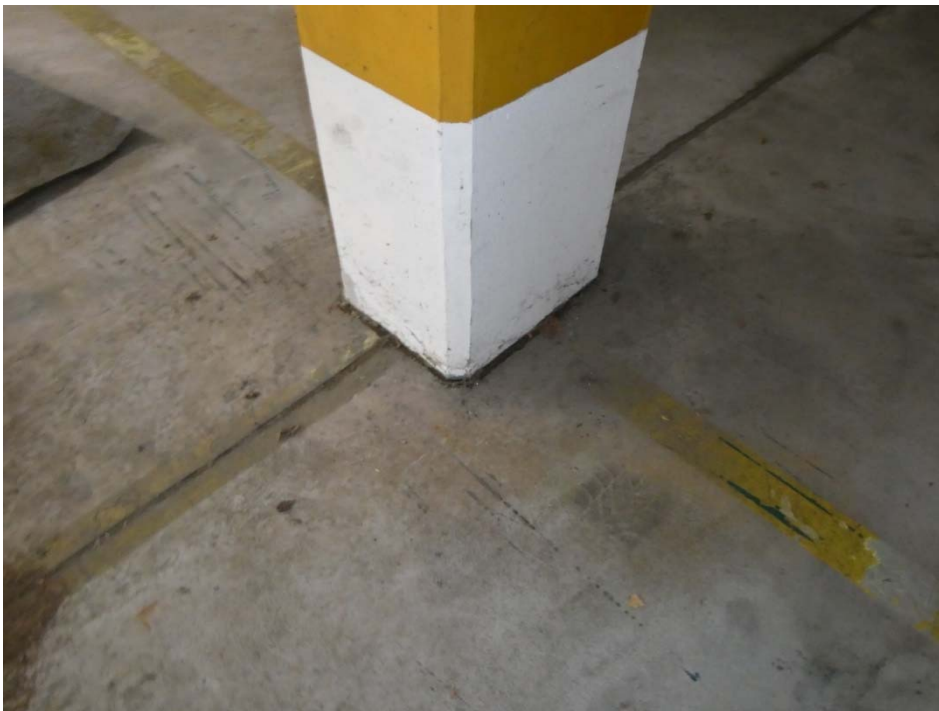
Untere Parkebene – Bodenschwindfugen, schadhafte Fugenverfüllung
